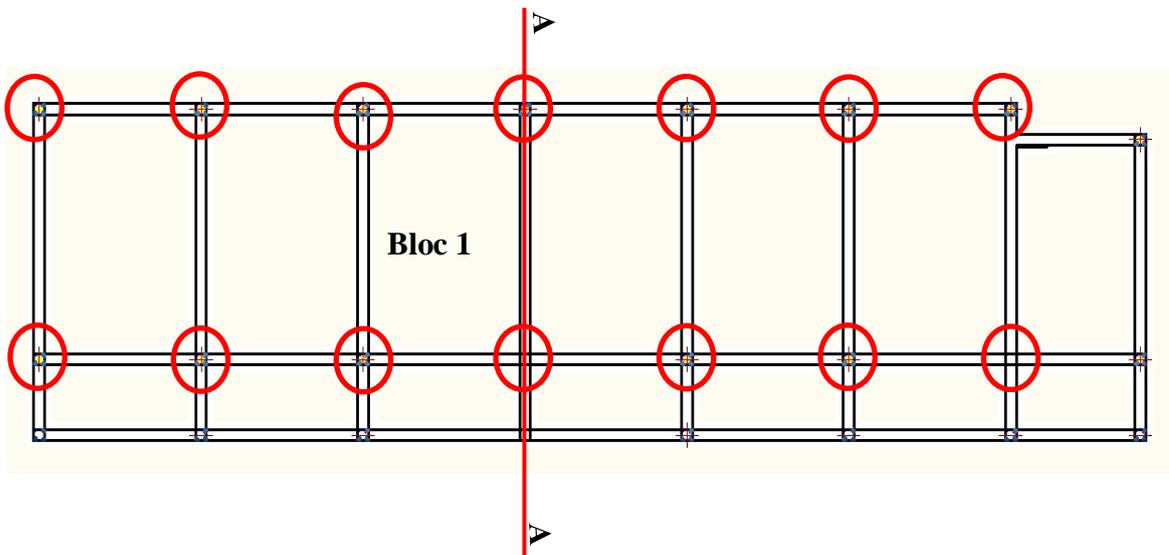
Augmentation de dimensionnement des poteaux (plan de RDC)
